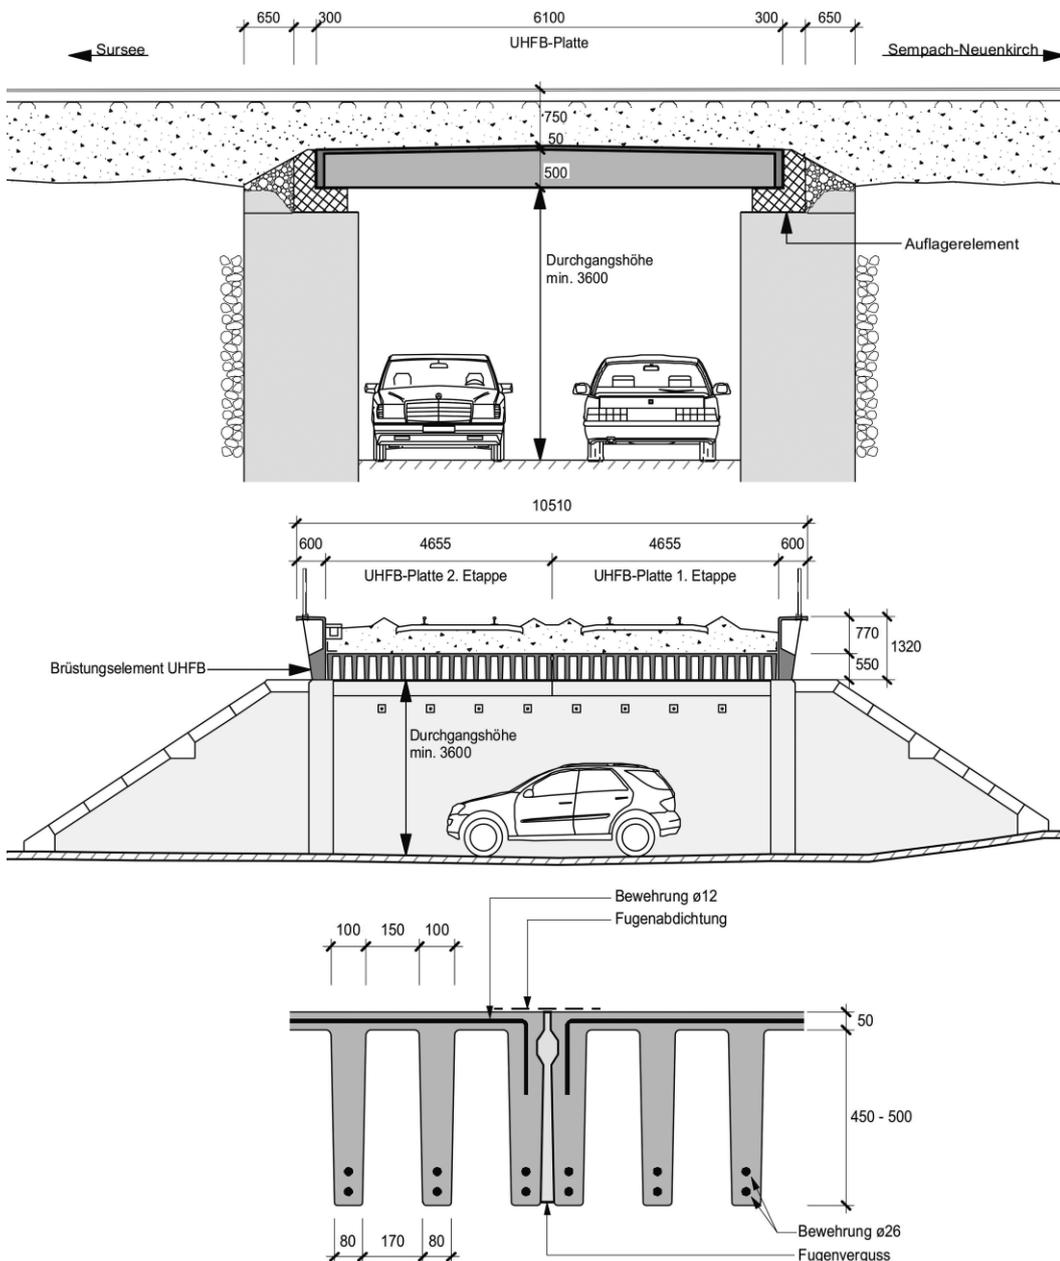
Ansicht, Querschnitt und Detail der Rippenplatte aus bewehrtem UHFB (Abmessungen [mm])
